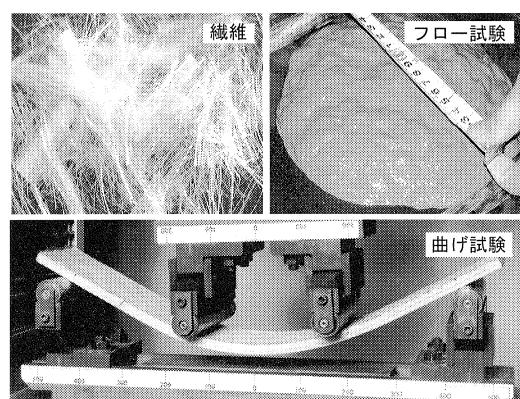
複数微細ひび割れ型纖維補強セメント複合材(HPFRCC)
